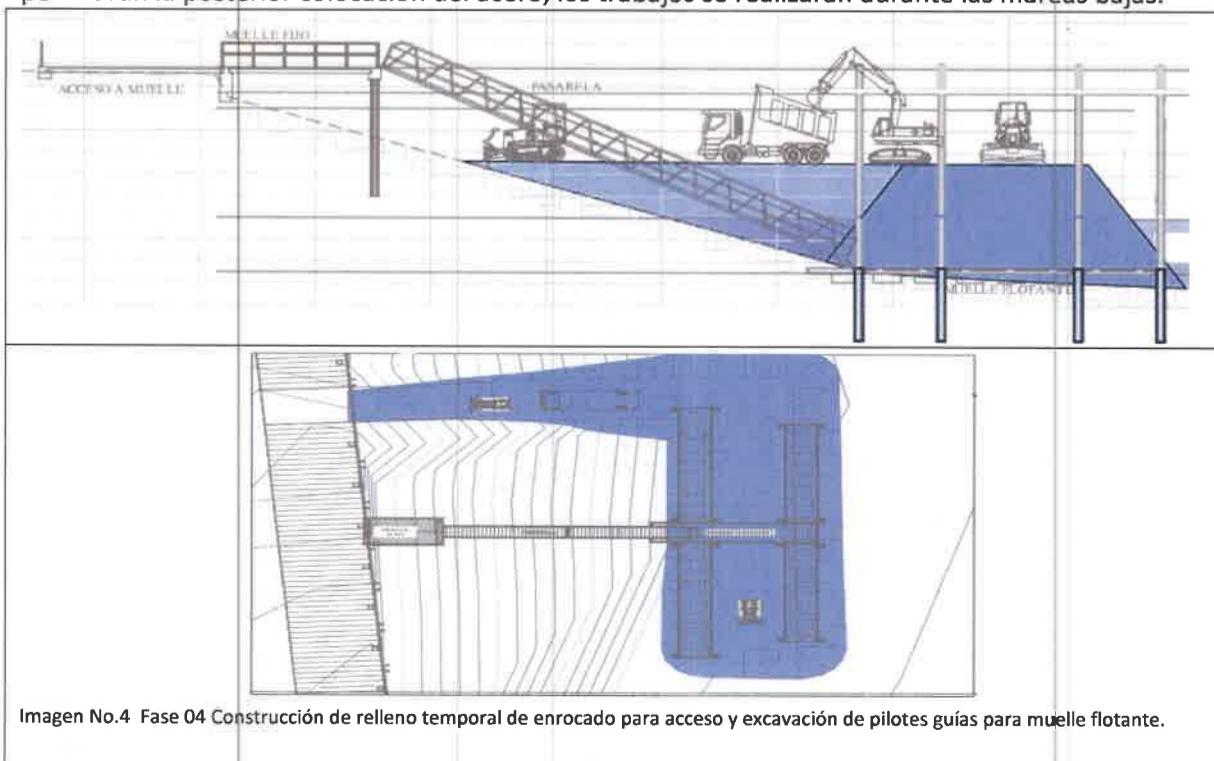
Fase 04 Construcción de relleno temporal de enrocado para acceso y excavación de pilotes guías para muelle flotante.
